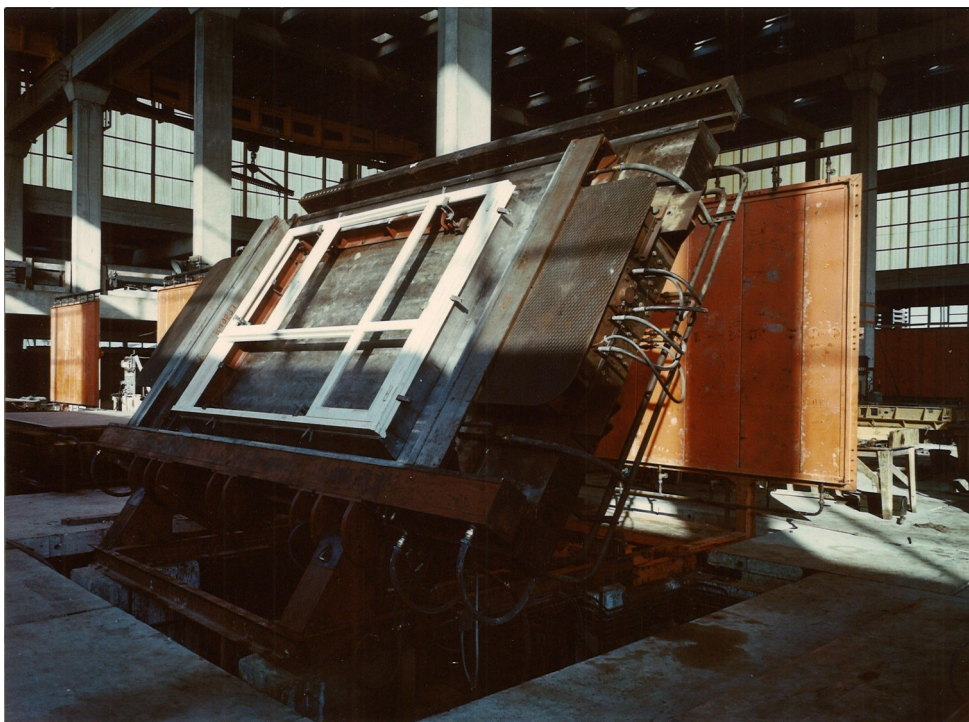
Form für Außenwände mit bereits eingebautem Fensterrahmen, Lille
